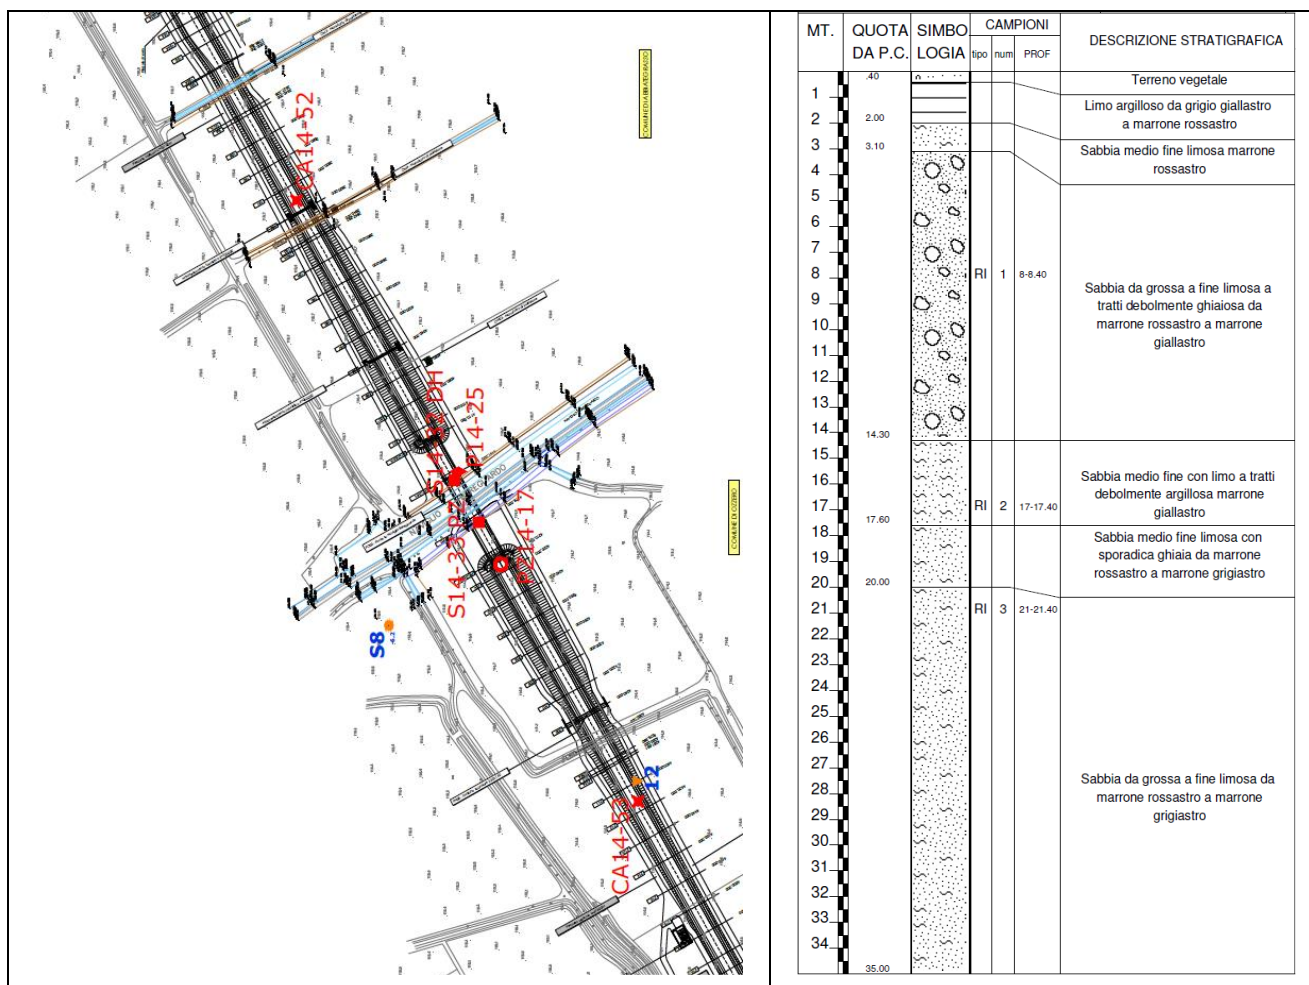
Stralcio planimetrico e stratigrafia sondaggio meccanico S41-32
